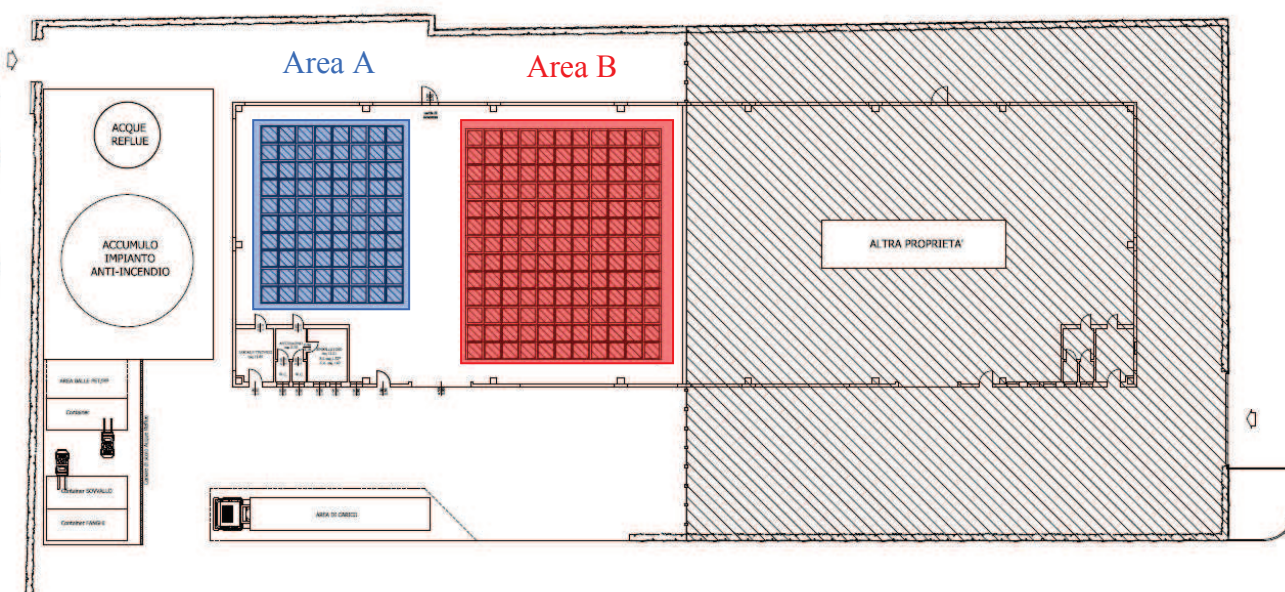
Planimetria dell'edificio con l'indicazione delle aree di stoccaggio (area A e B);
